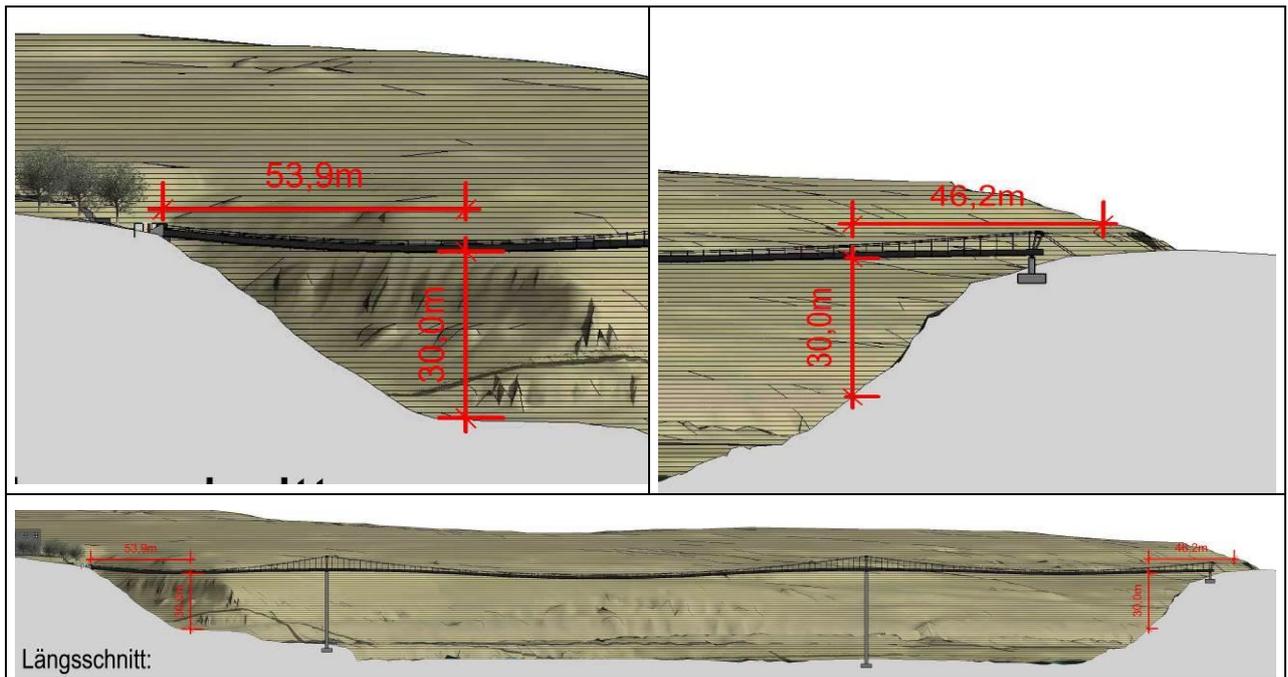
Längsschnitt des südlichen Hauptbrückenschlags (Brückenabschnitt 1) mit Darstellung der ausgleichsrelevanten Brückenhöhe von 30 m sowie der Strecke zum jeweils nächstgelegenen Widerlager, unmaßstäblich
